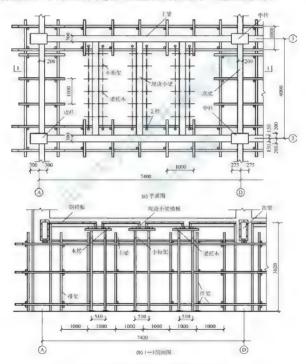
框架梁、柱模板采用扣件式钢管脚手架支设 (单位: mm)
